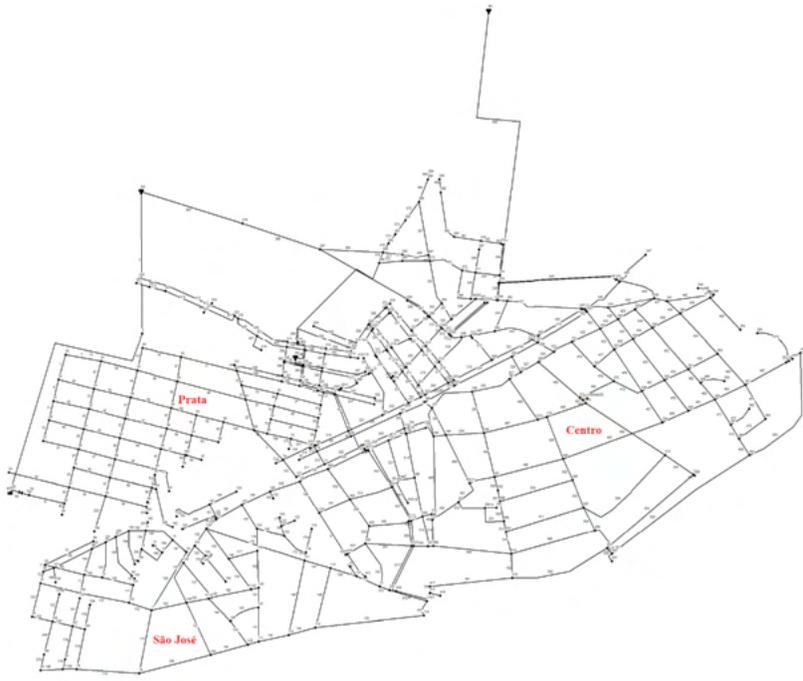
Planta baixa da rede de abastecimento de Campina Grande.
